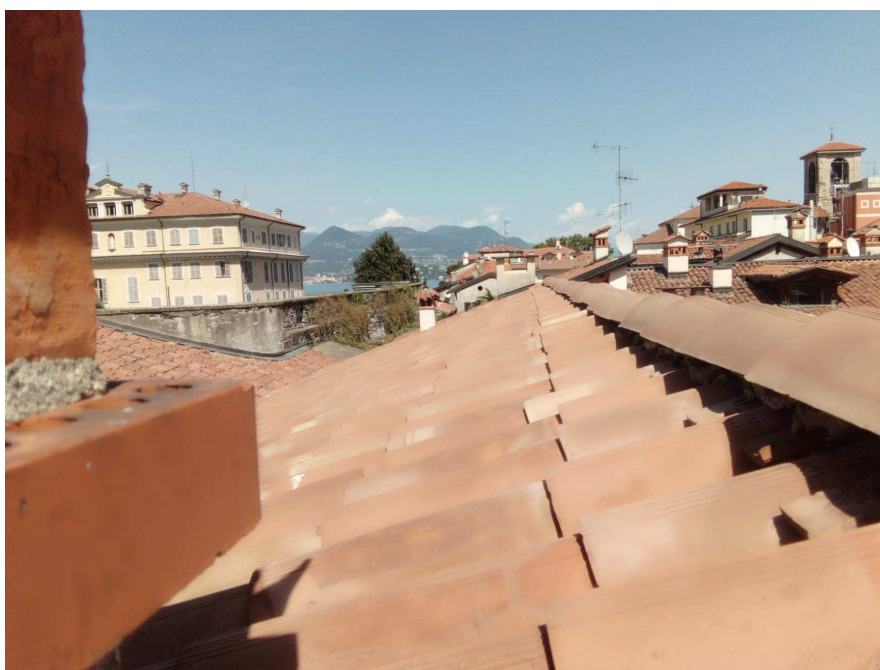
FOTO VII – VISTA DEL COLMO LATO P.ZZA SIRTORI
